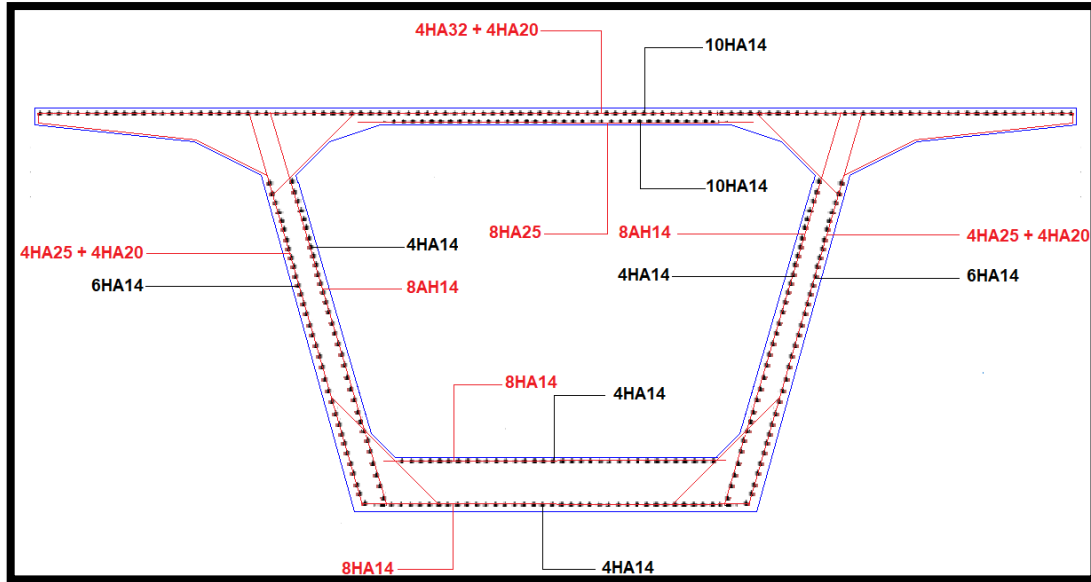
Schéma du ferrailage passif du voussoir sur pile.
